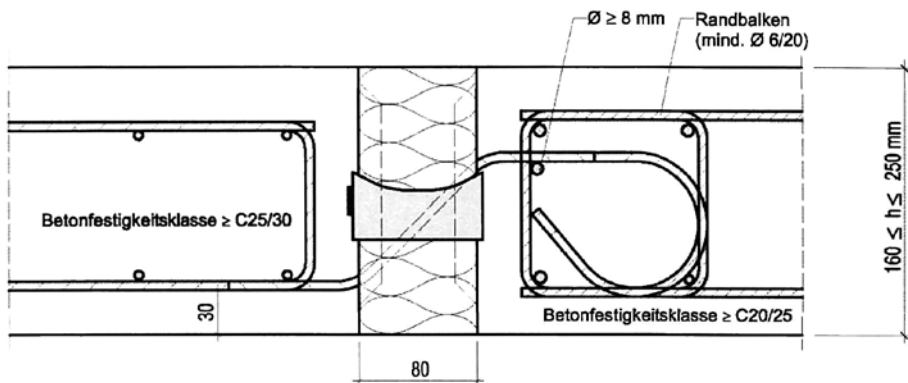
Beispiel Schöck Isokorb Typ Q mit Aufhängebewehrung
